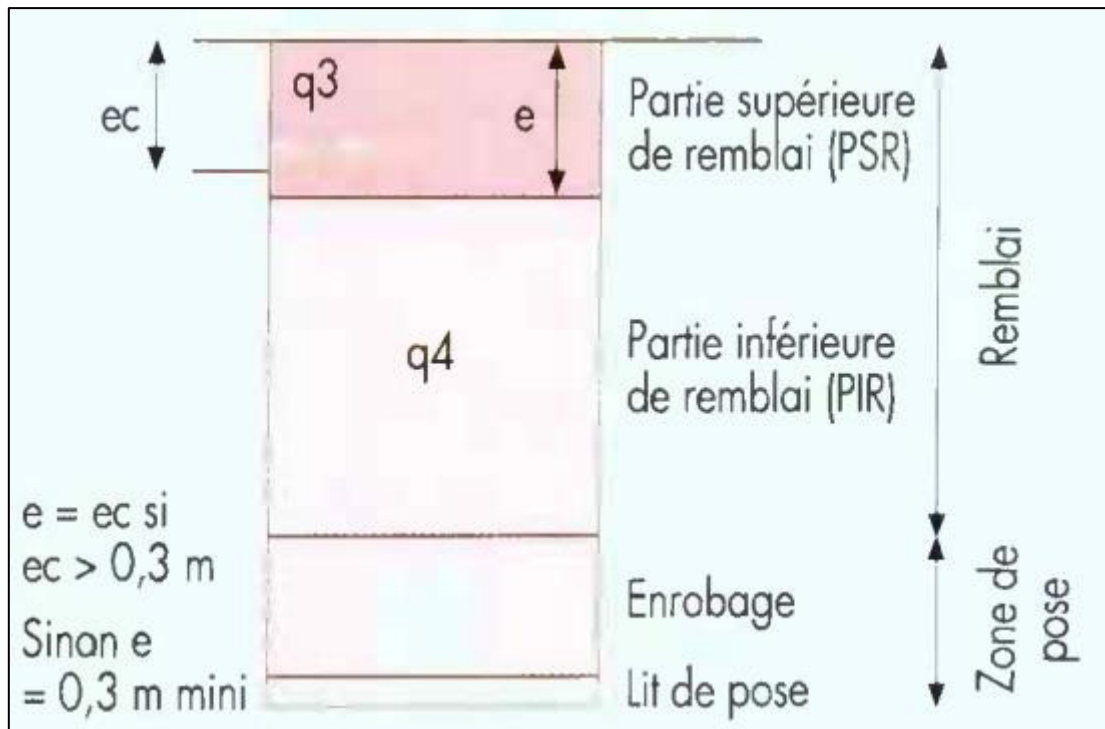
Cas d'une tranchée sous accotement, Guide de remblayage des tranchées et réfection des chaussées
